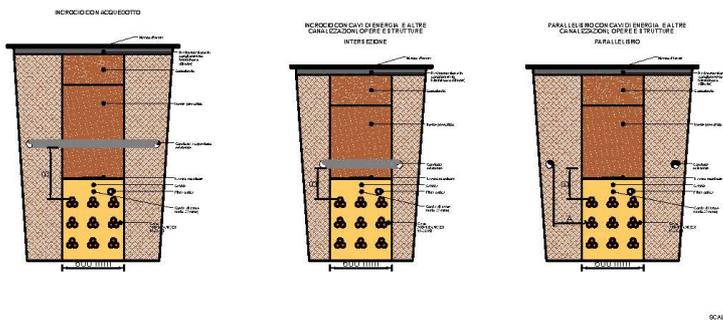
Particolare sezione tipo cavo interrato e particolari della sezione stradale
